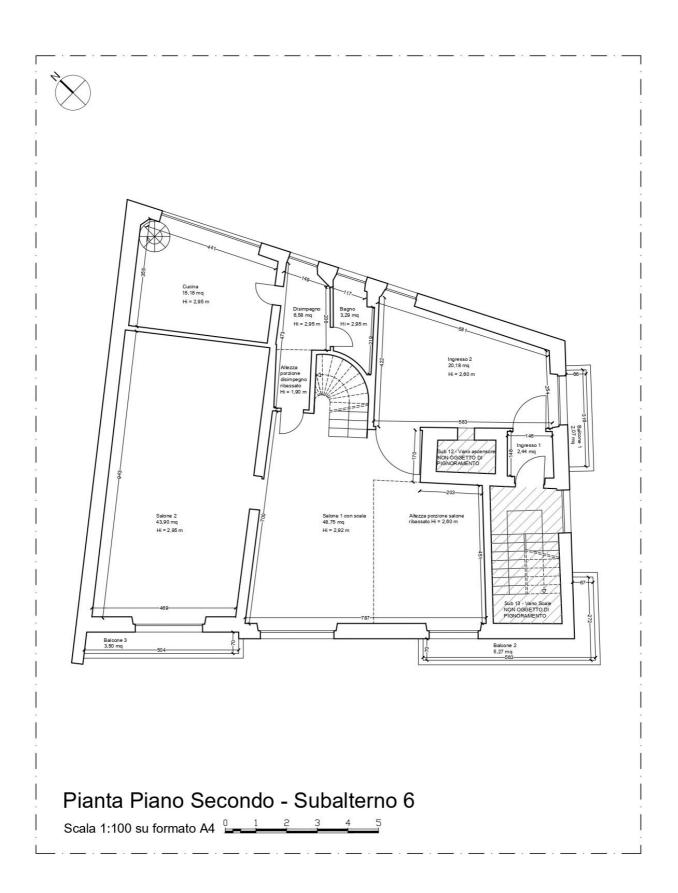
Piano Secondo – Subalterno 6 Planimetria dello stato di fatto rilevato
